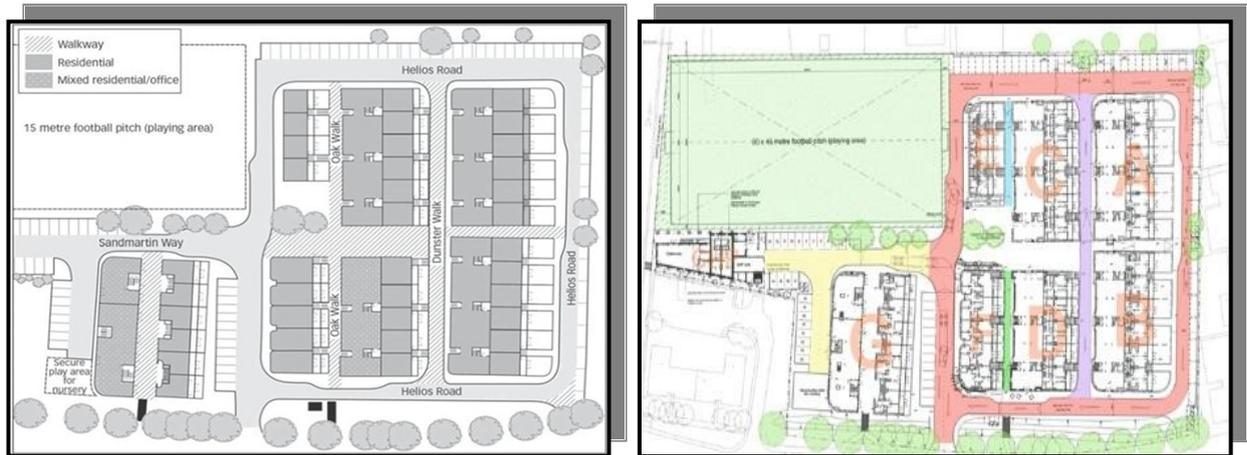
plan de masse BedZed, source : habiter-autrement.org
